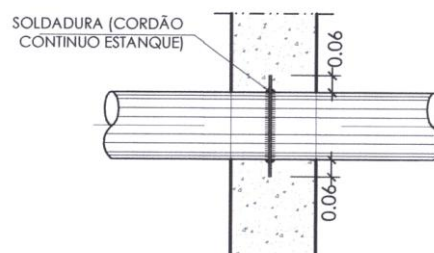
Junta de impermeabilização passa-muros (pormenor de projecto)
